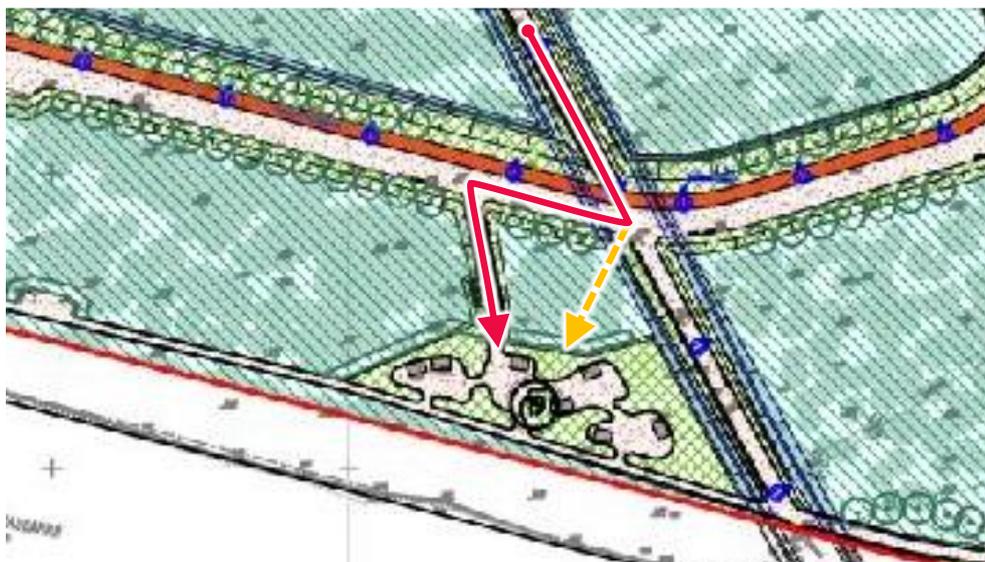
Площадка не имеет связи с близлежащим перекрёстком. Неизбежно появление тропы в этом месте (по пунктирной стрелке)
